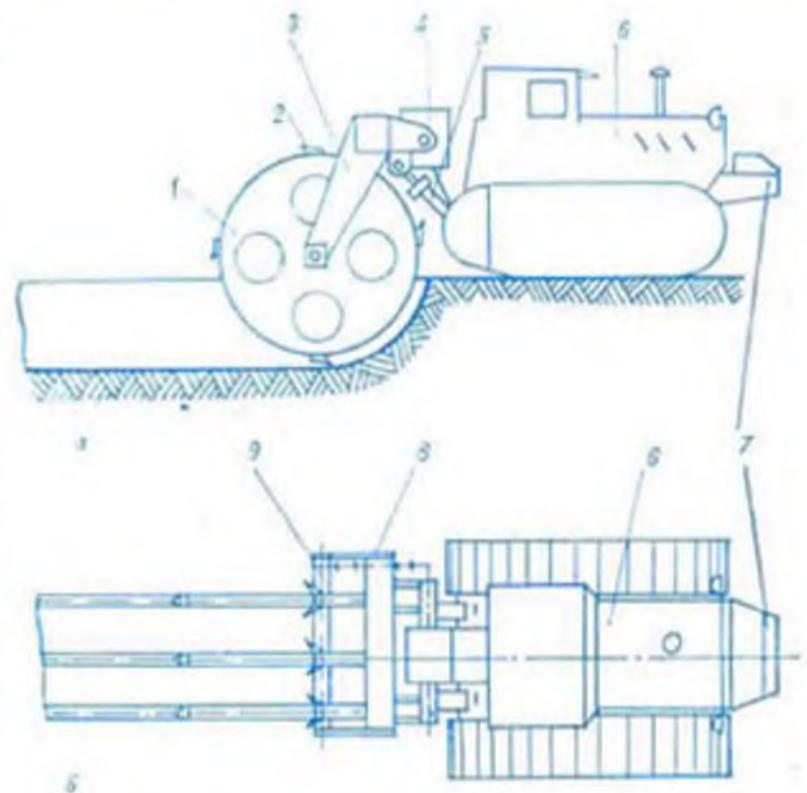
Дискофрезерная щелерезная машина: а, б — вид сбоку и сверху; 1 — диски, 2 — резцедержатели с резами, 3 — рама, 4 — редуктор, 5 — гидроцилиндры, 6 — трактор, 7 — противовес, 8 — привод, 9 — лыжа.
